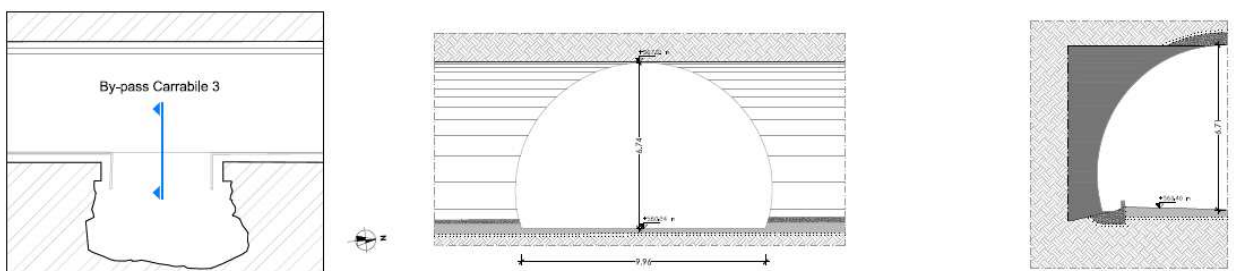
Planimetria, prospetto e sezione by pass carrabile
